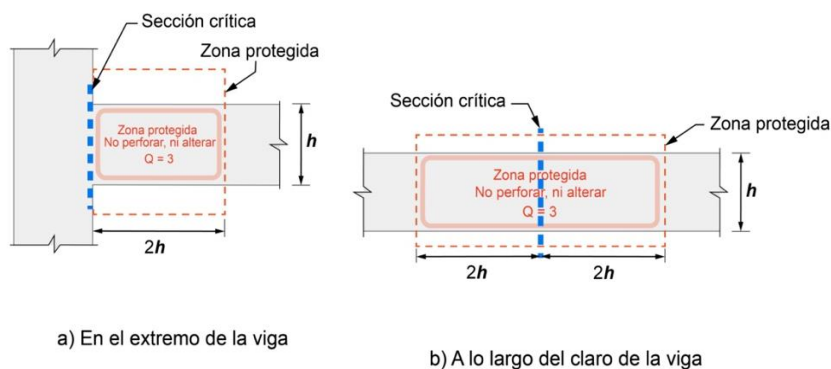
Ejemplos de identificación de zona protegida en un plano de construcción
